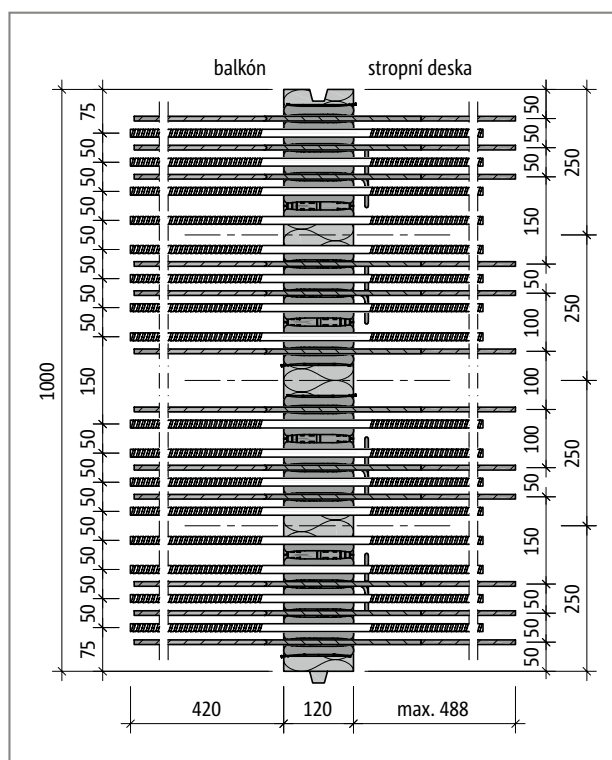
Schöck Isokorb® CXT typ KL-M5-V2: Řez prvkem
